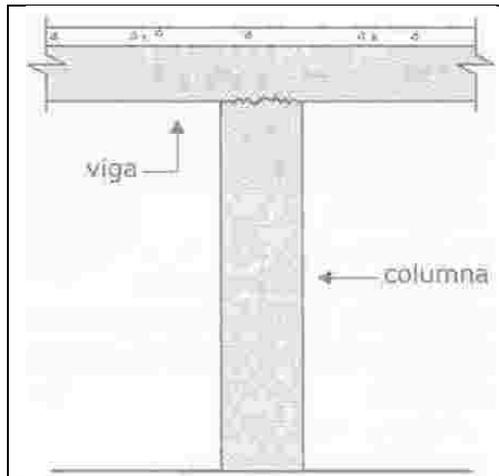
Fisuras de junta de hormigonado¹⁷
